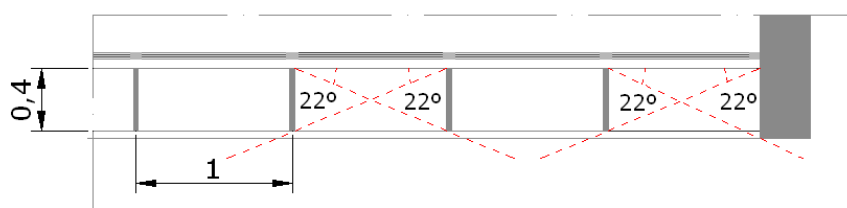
Planta esquemática com protetores verticais com cotas em metro (m).
